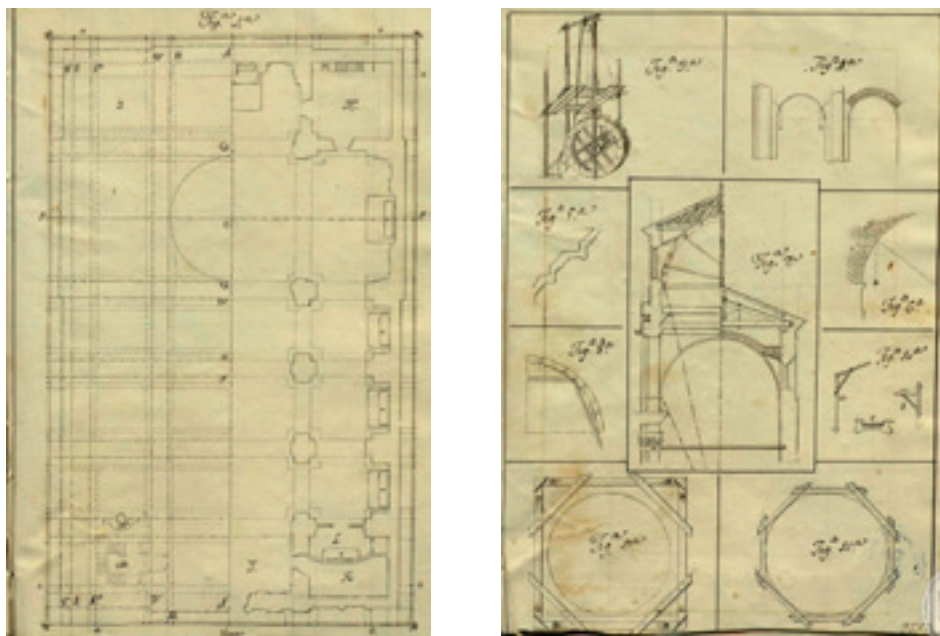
Fray Joaquín del Niño Jesús. Planta de una parroquia claustrada. Elementos de la construcción. 1821. Biblioteca de las Cortes de Aragón, Zaragoza.
